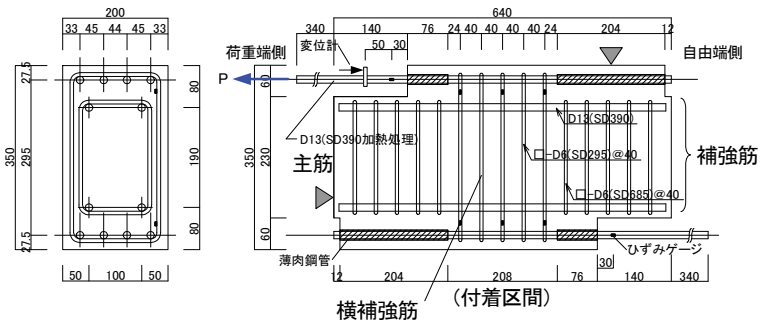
試験体の形状・寸法、配筋 (試験体Bo4)
